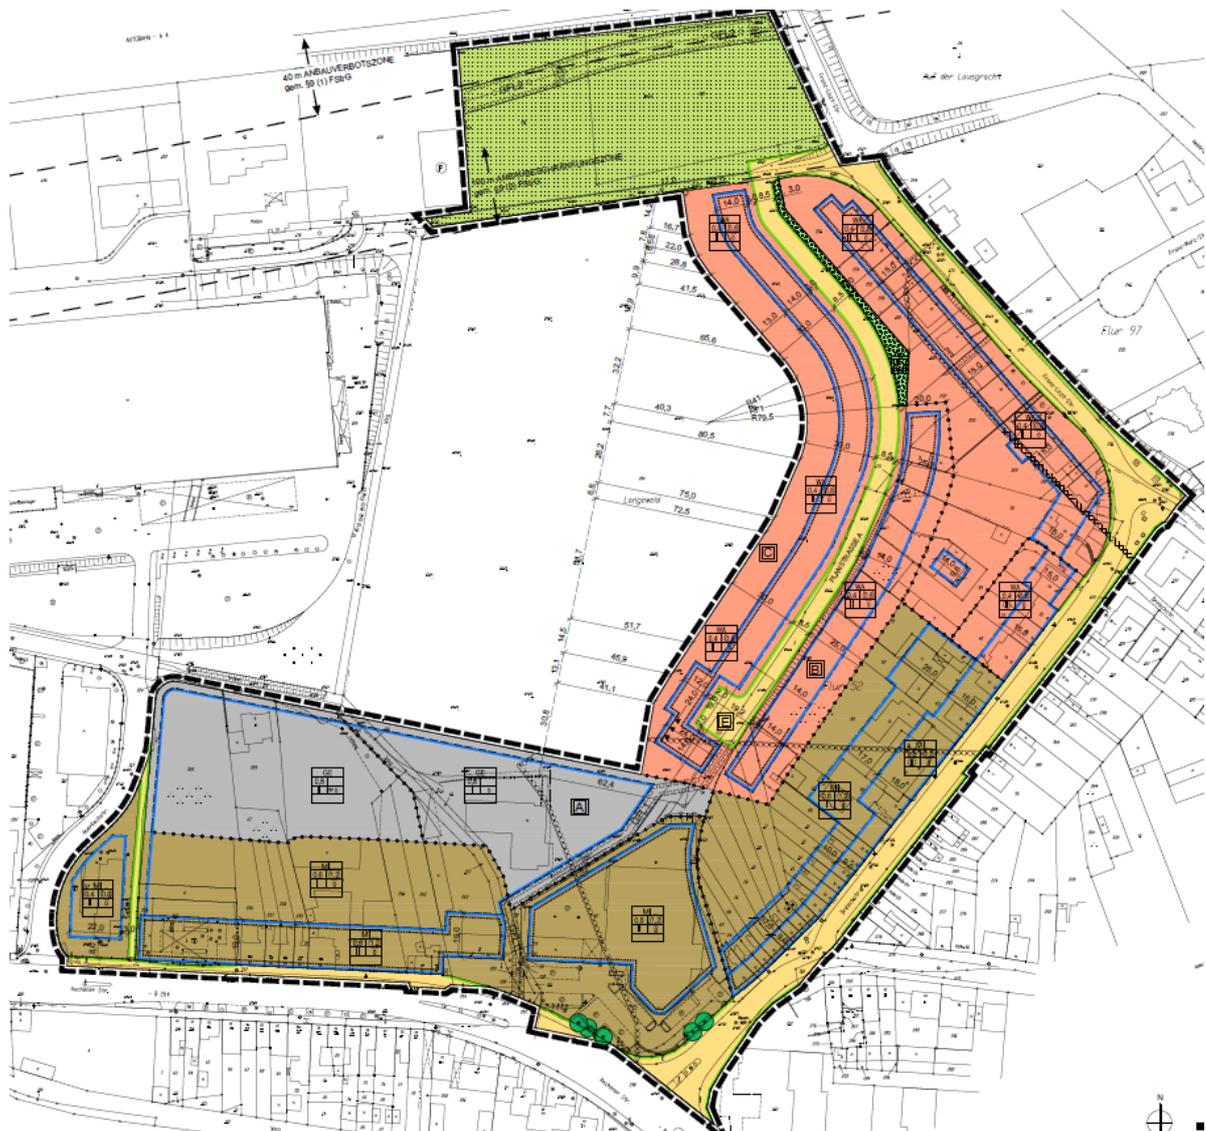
Auszug aus dem Bebauungsplan 271 A – Auerbachstraße – (rechtskräftig seit dem 17.11.2007) der Stadt Eschweiler [Quelle: Stadt Eschweiler], ohne Maßstab
